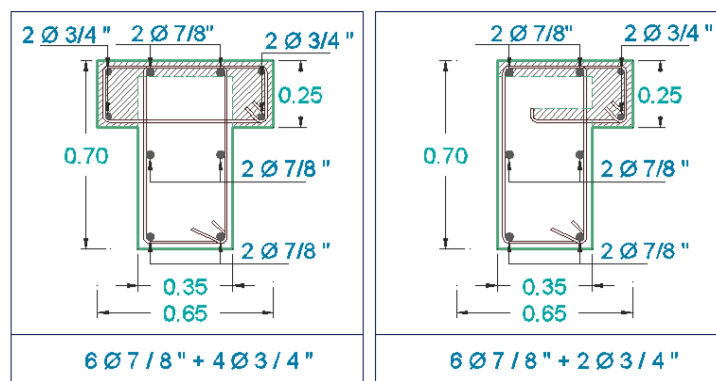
REFORZAMIENTO DE LAS COLUMNAS DEL PABELLÓN 1A.
